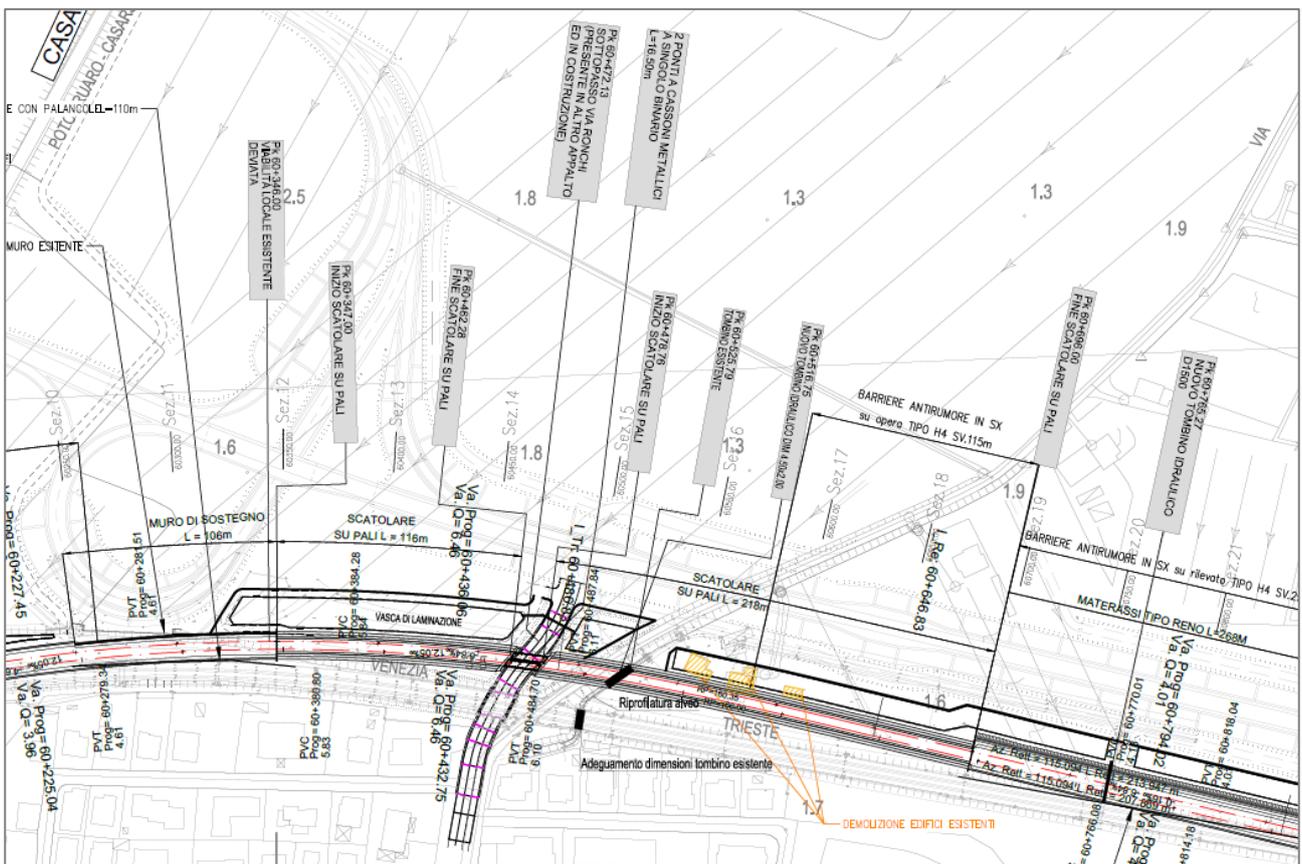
Variante di Portogruaro: Planimetria di progetto – Scatolari su pali
